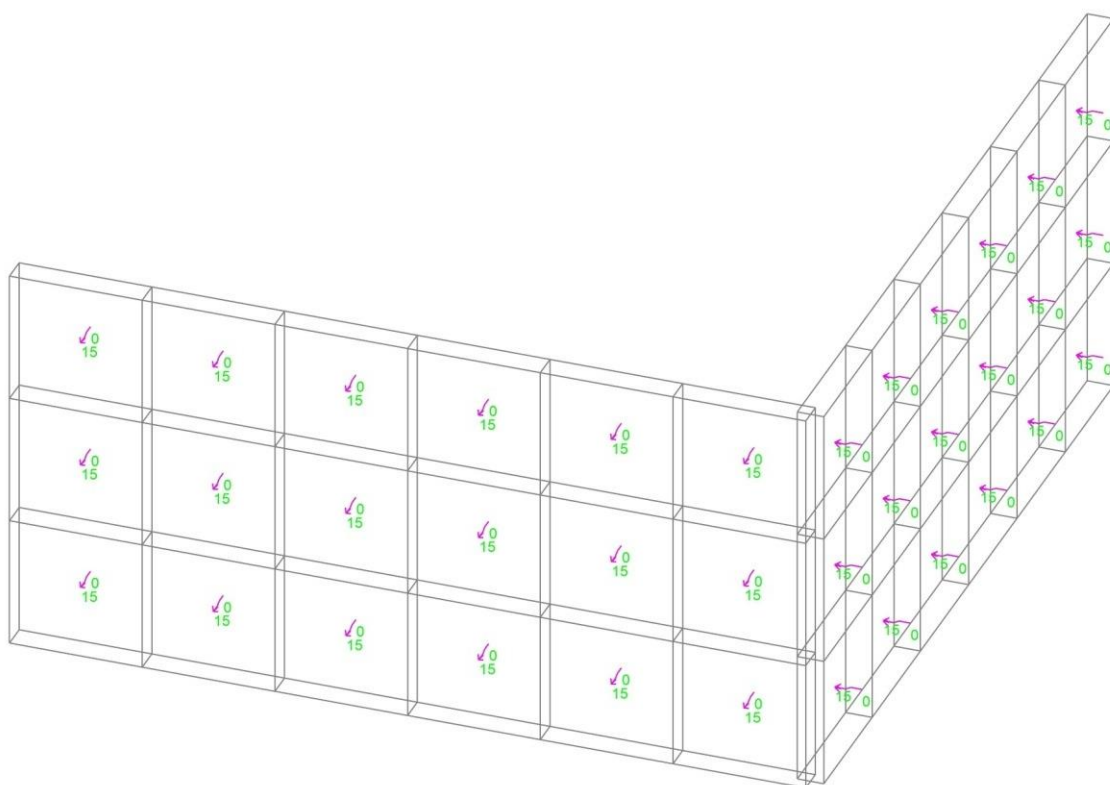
Расчетные температурные нагрузки при нагреве конструкции (разработано автором)
